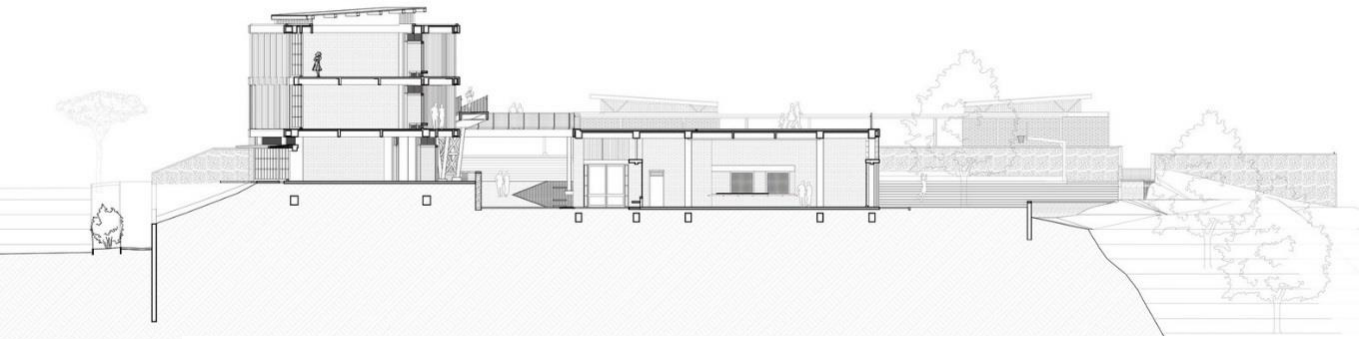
instituto samaria /campuzano arquitectos Secciones transversales Fuente.
